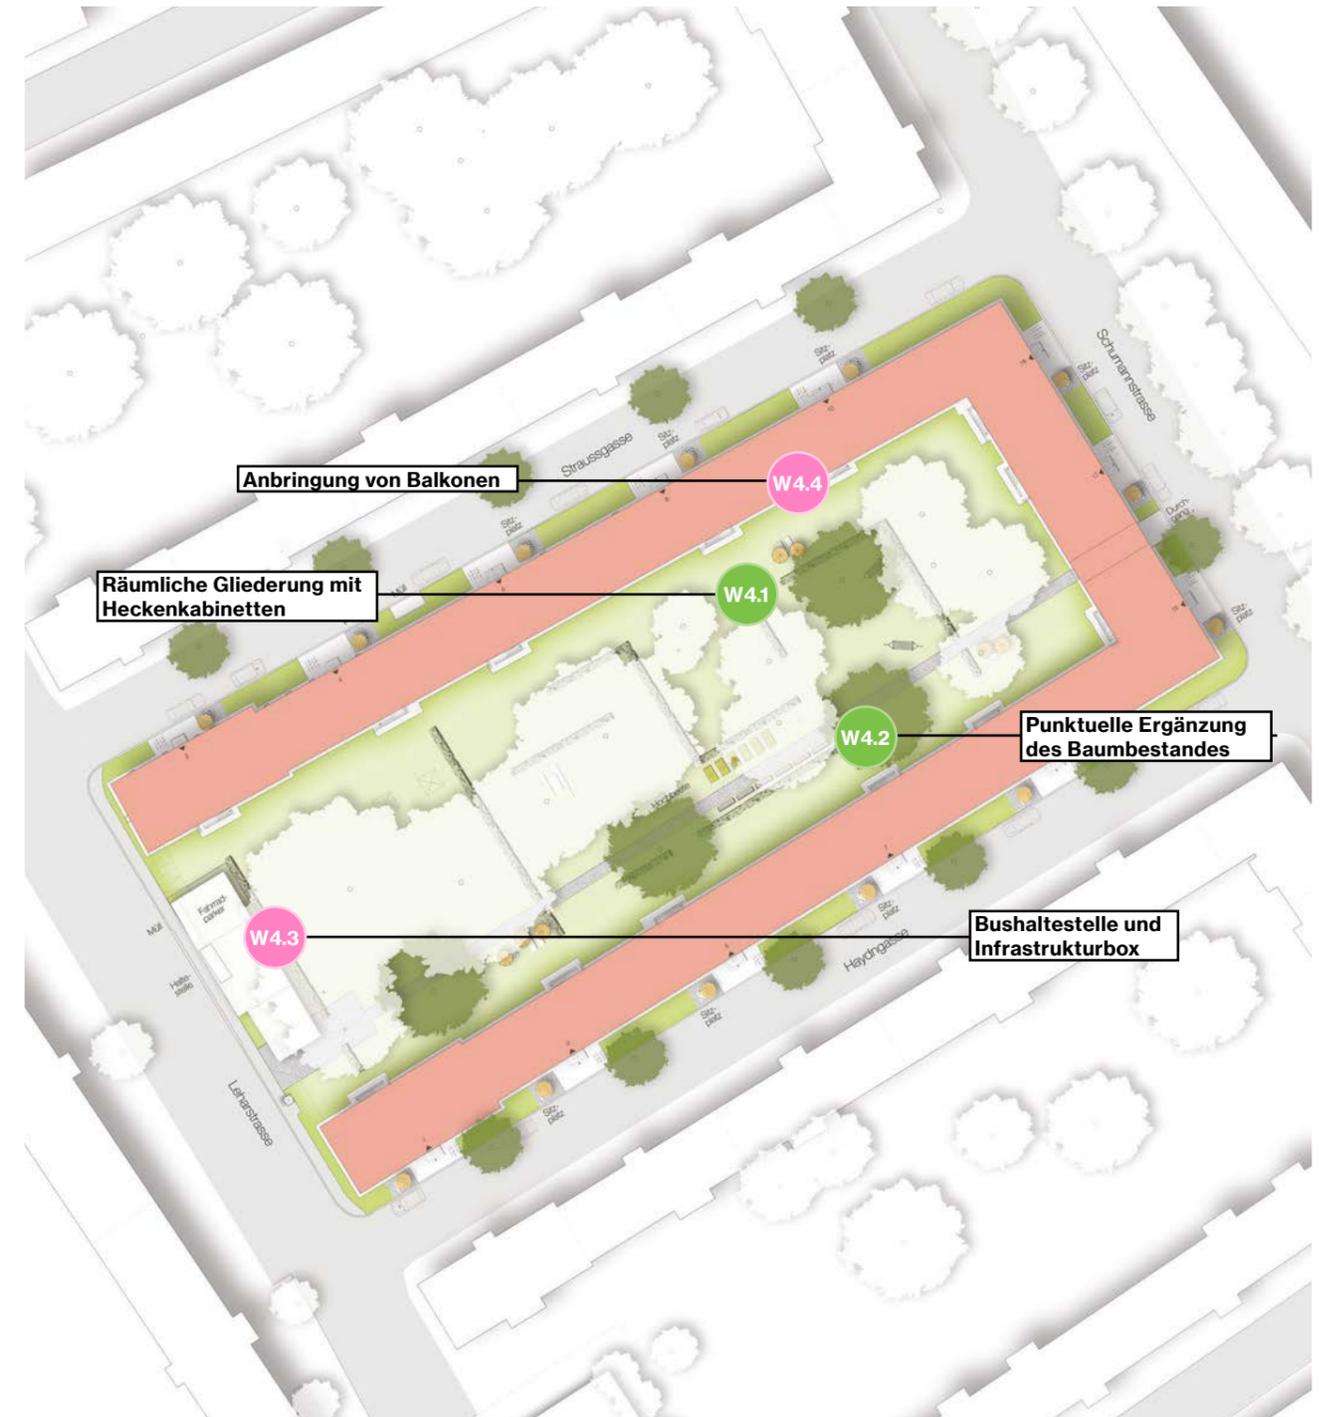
Detailplan Prototyp Straußgasse, Darstellung: DnD Landschaftsplanung
